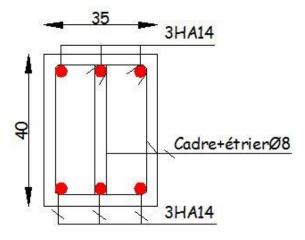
schéma de ferraillage de la poutre brisé en appui et en travée.
